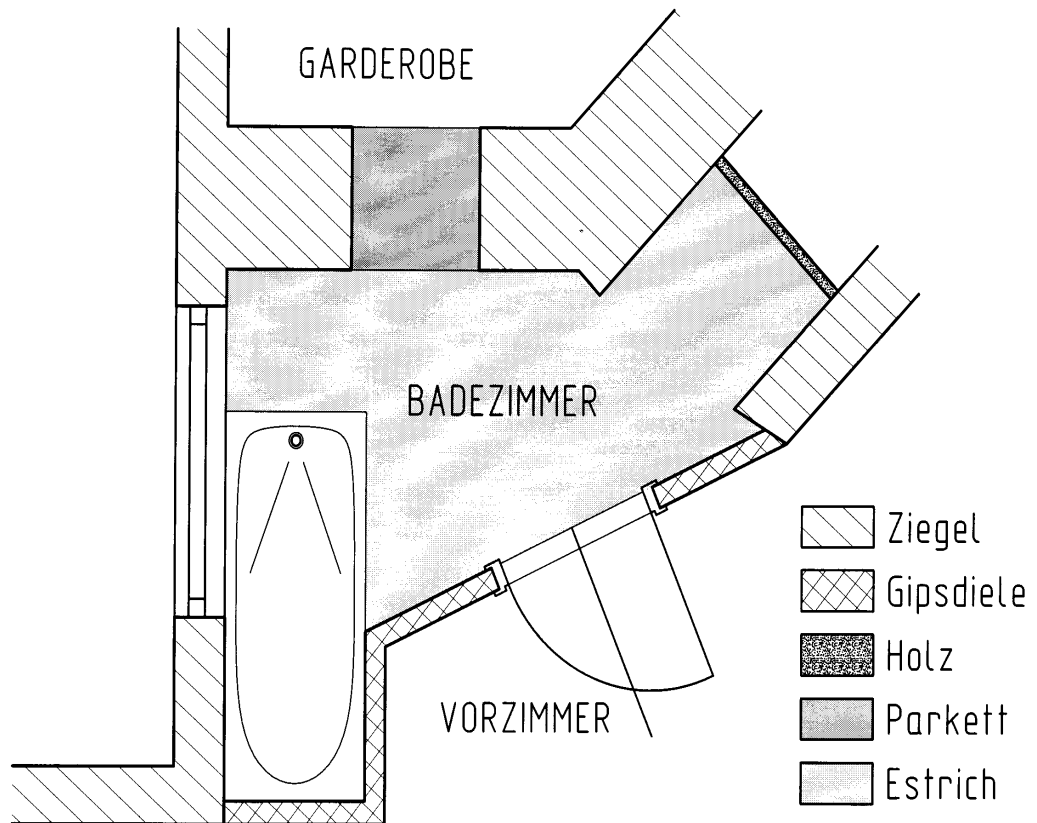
Grundriss Badezimmer - Fallbeispiel 5
